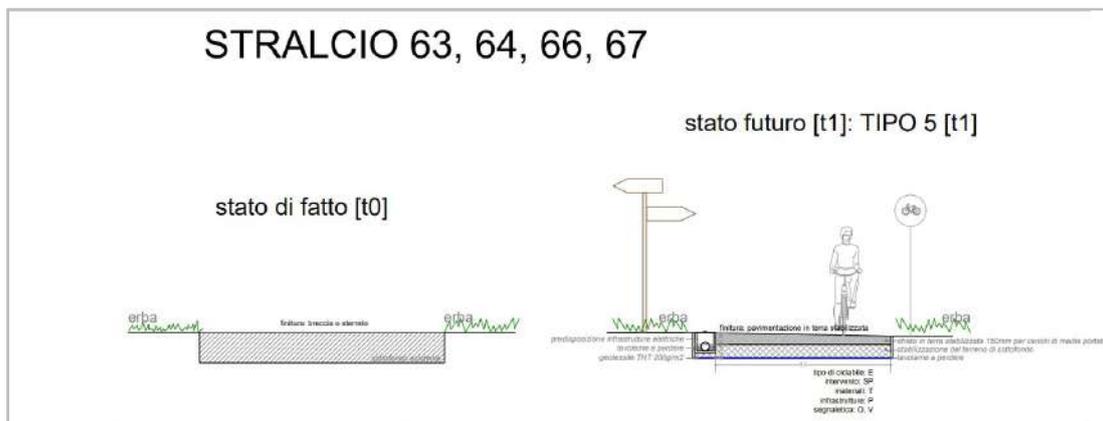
Stato attuale, Stato futuro e fondo di progetto di tipo 5
